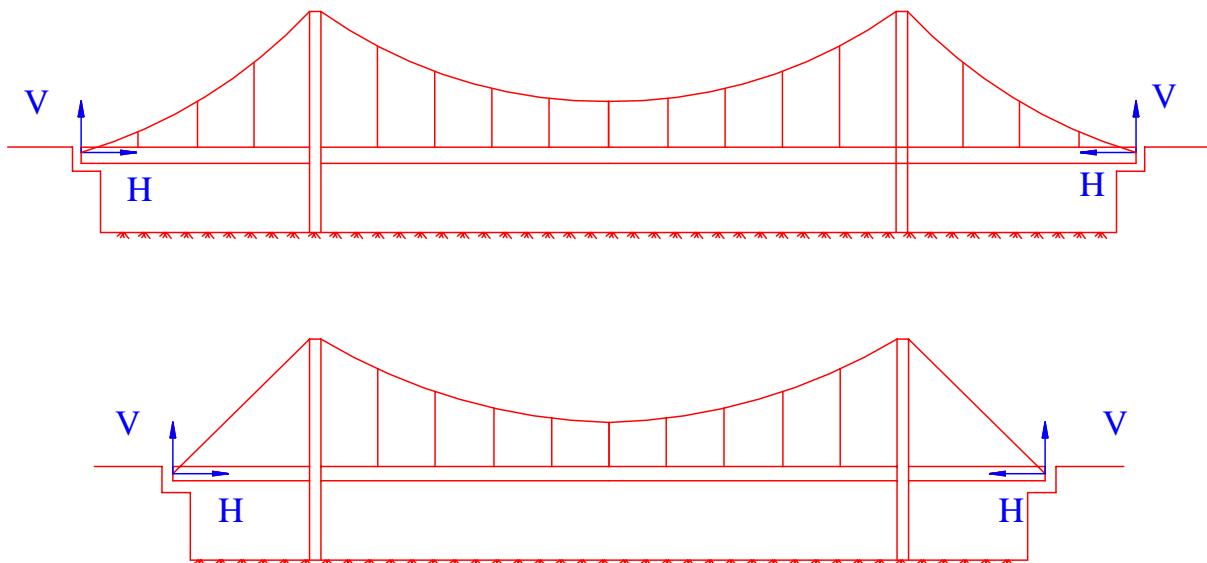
Sơ đồ cầu treo 3 nhịp
